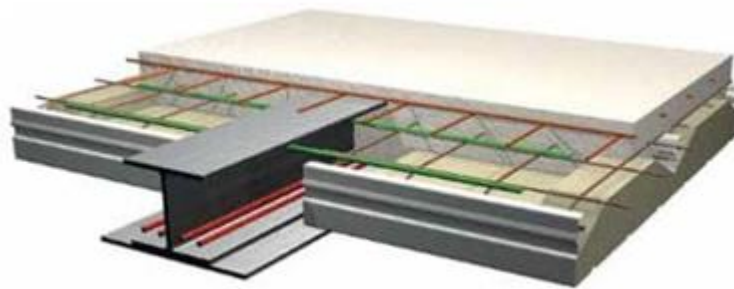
Plancher mixte avec poutrelle en acier [95].
